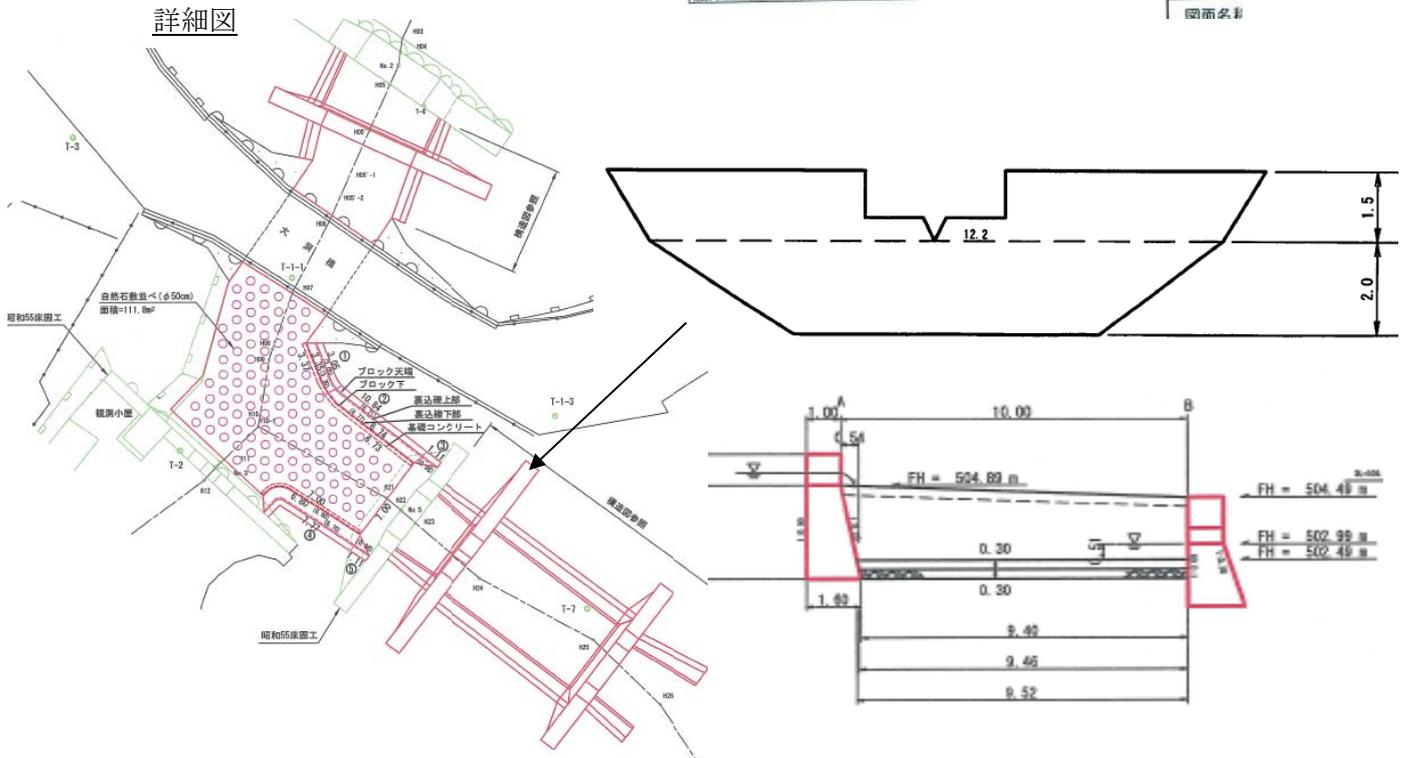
B流域量水施設 設置位置(案) (上段：平面図、下段：詳細図)
